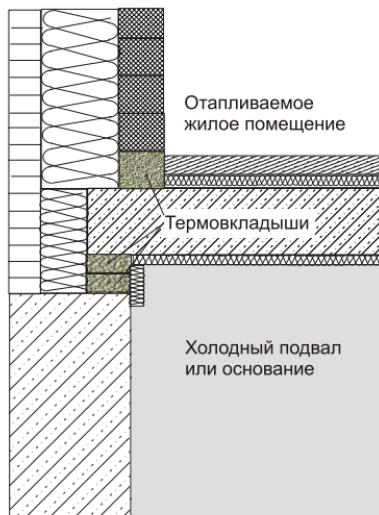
Ликвидация "теплового мостика" в месте стыка полой наружной стены с подвальным перекрытием и подвальной стеной или с плитой основания и фундаментной стеной за счет установки термовкладыша
